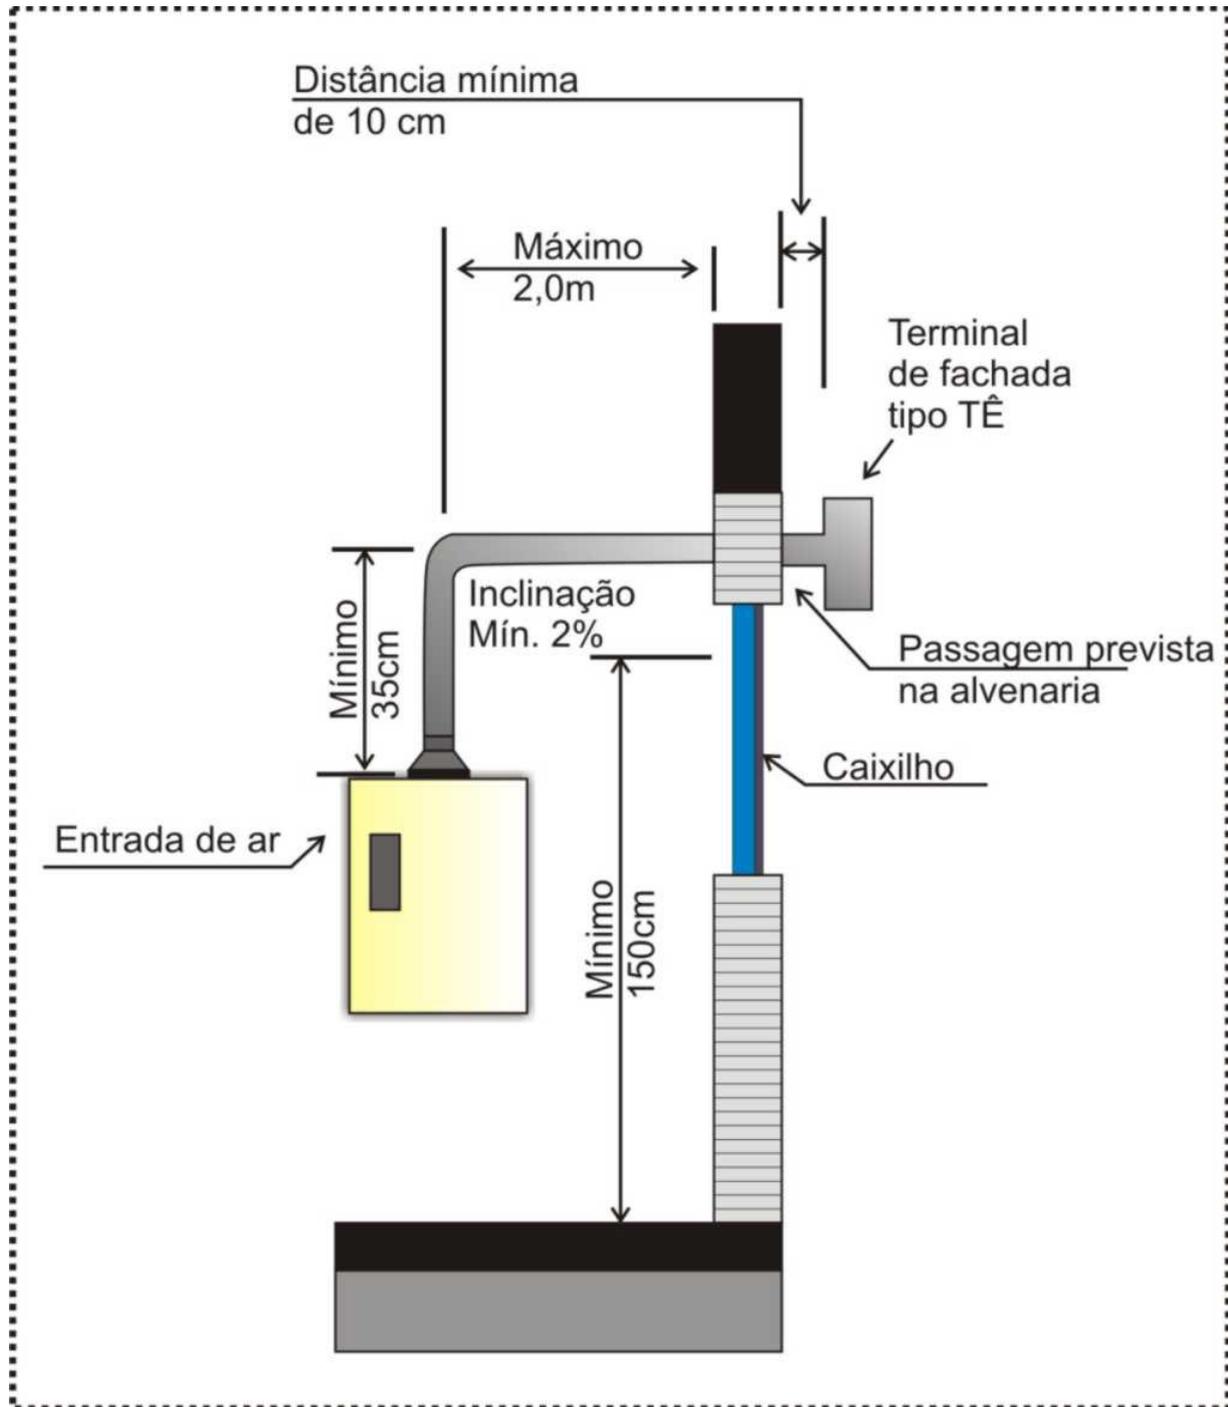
Detalhes da instalação de um aquecedor de passagem – Corte.
